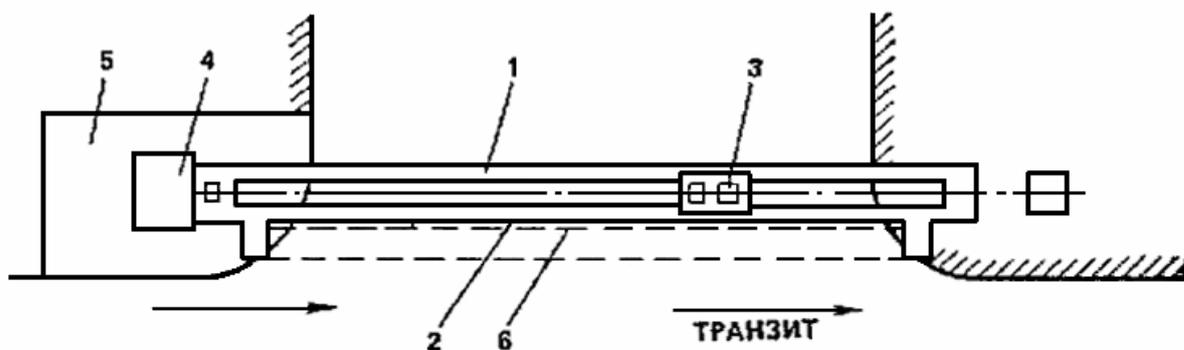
Схема расположения конструкции рыбозащитного устройства типа плоской сетки
